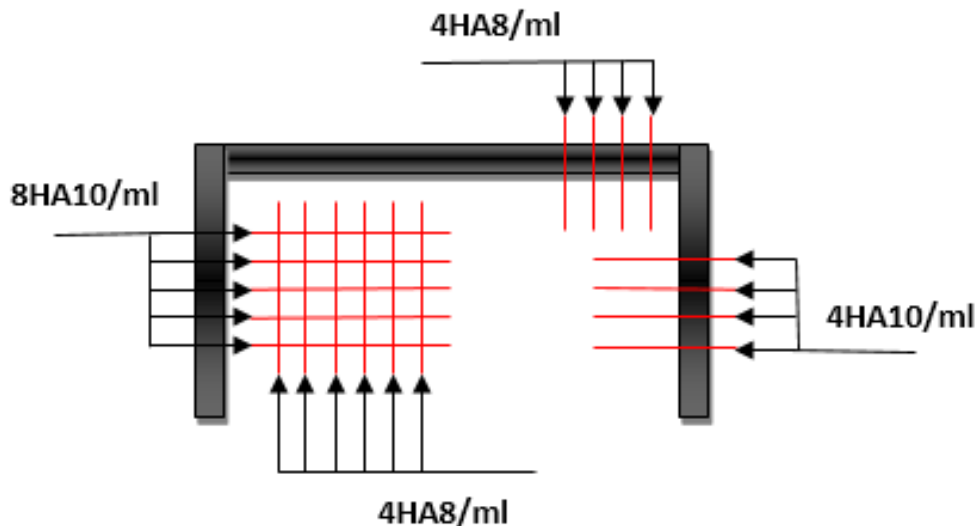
Schéma de ferrailage dalle pleine sur 3 appuis
